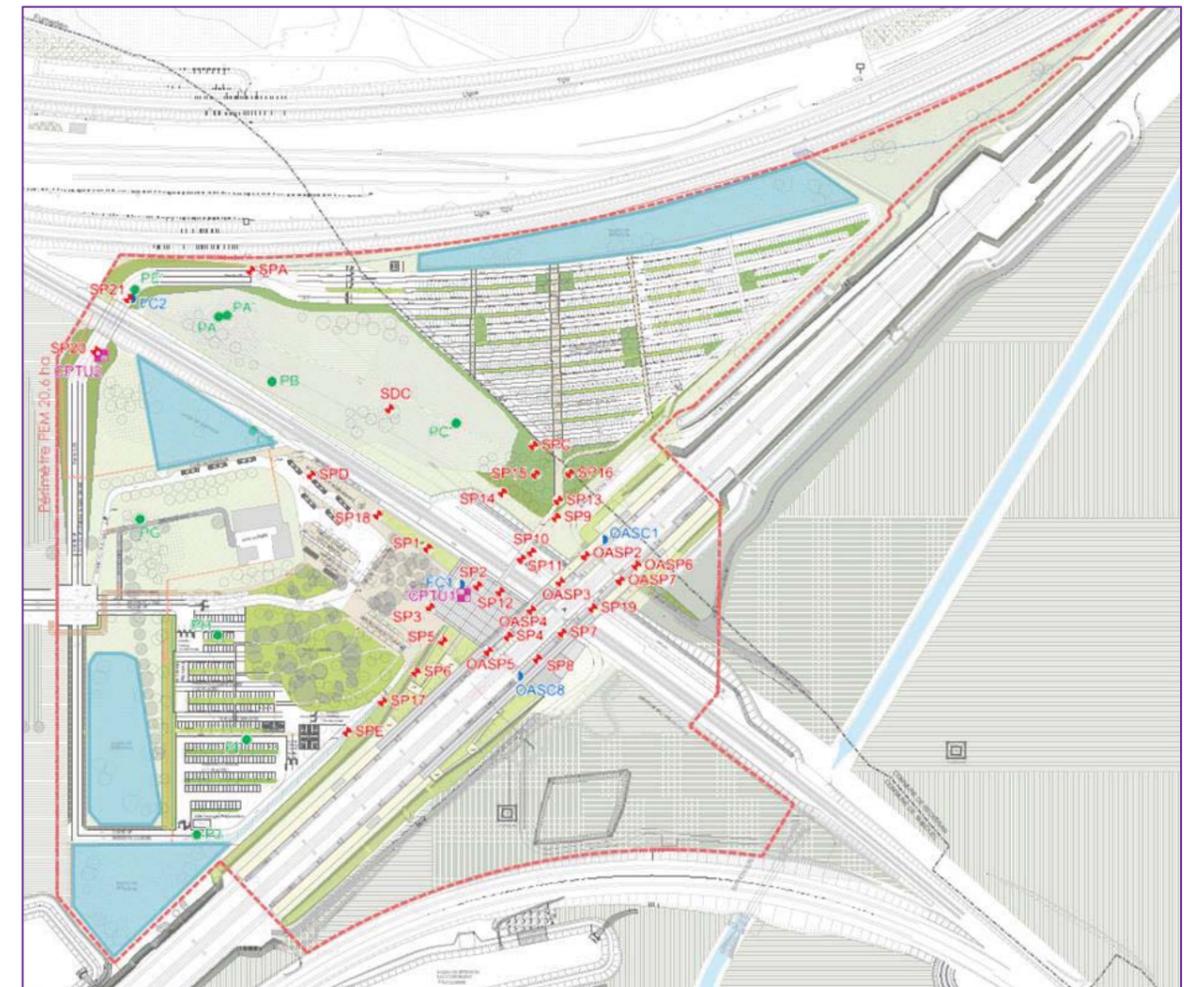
Plan d'implantation des sondages géotechniques (Source : AREP Ville, Gares & Connexions, 2016)
